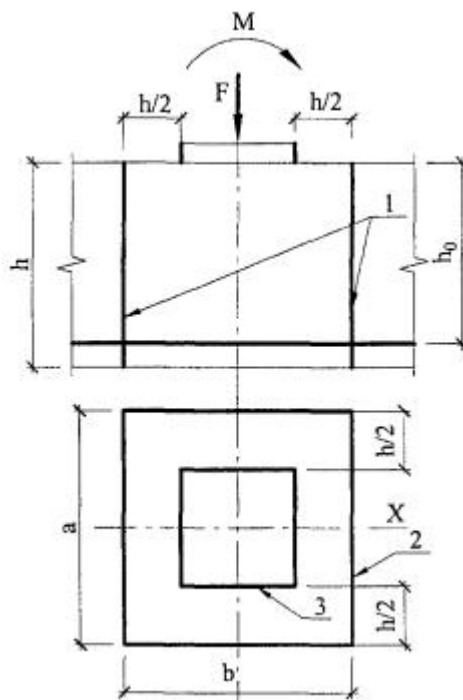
Схема для расчета железобетонных элементов на продавливание
